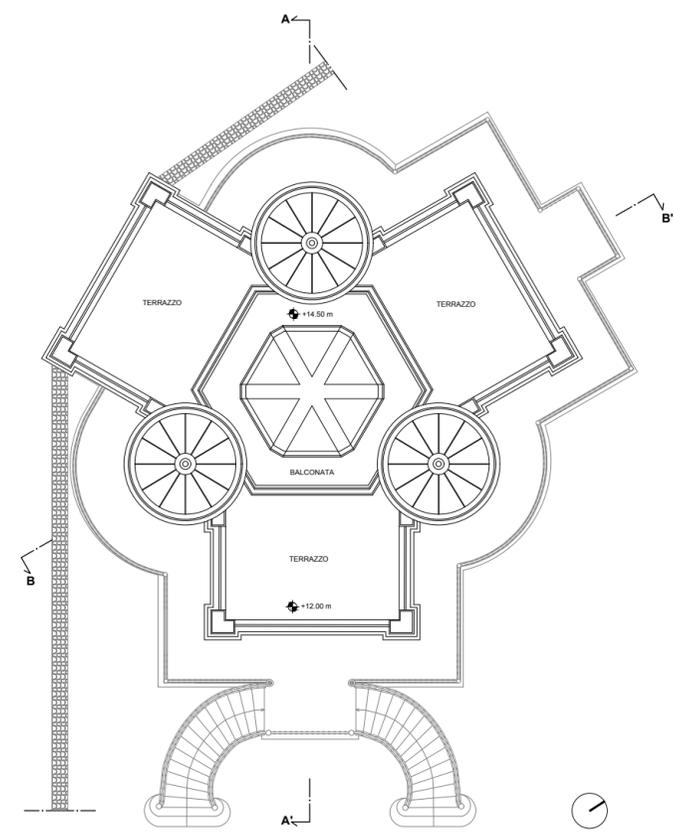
\_Pianta piano coperture La Bizzarria - scala 1:200
